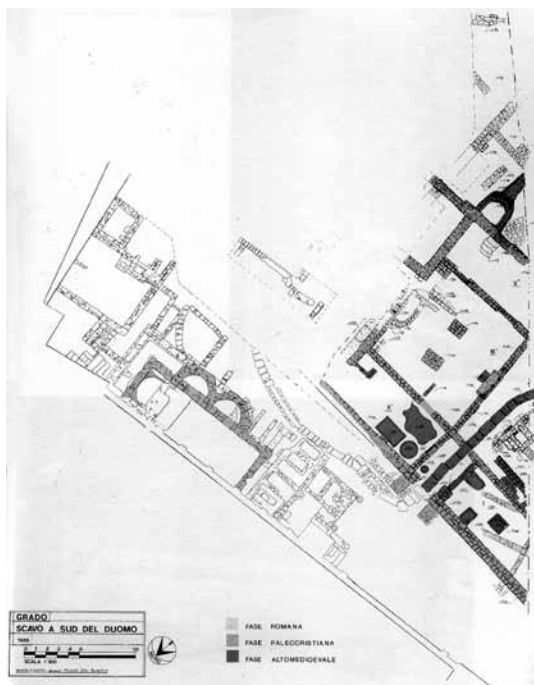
Planimetria dell'episcopo di Grado (da LOPREATO 1988)
